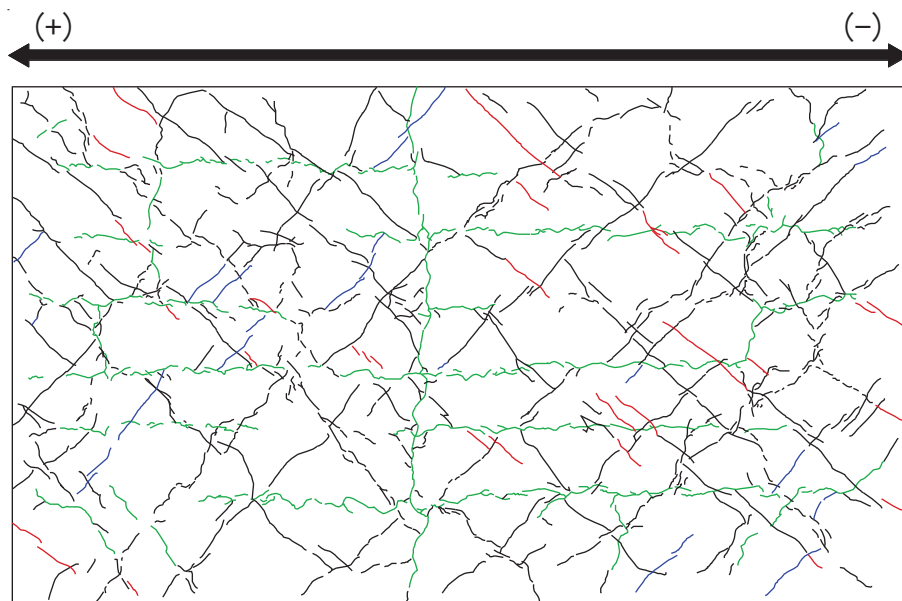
(10) 乾燥試験体 [1] 1/333rad. におけるひび割れ図
